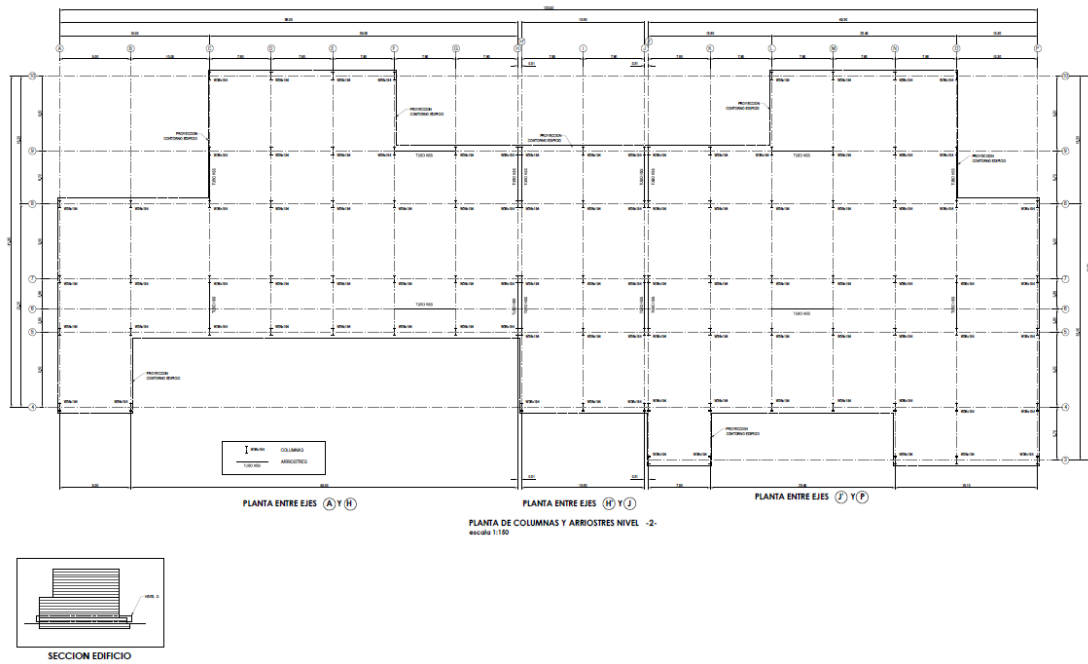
Planta Estructural Columnas, Muros y Arriostres. Nivel 2
